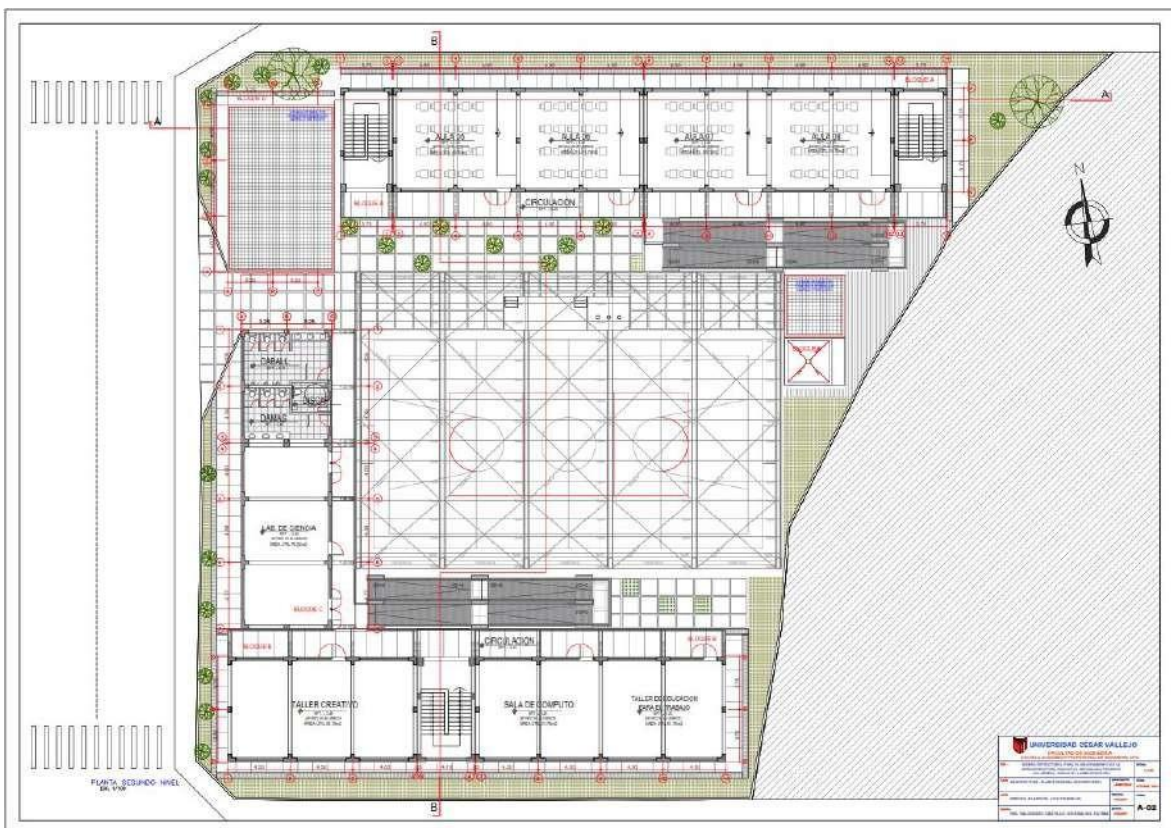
Plano A-02: Arquitectura – Planta general segundo nivel, 08-10-2021.
